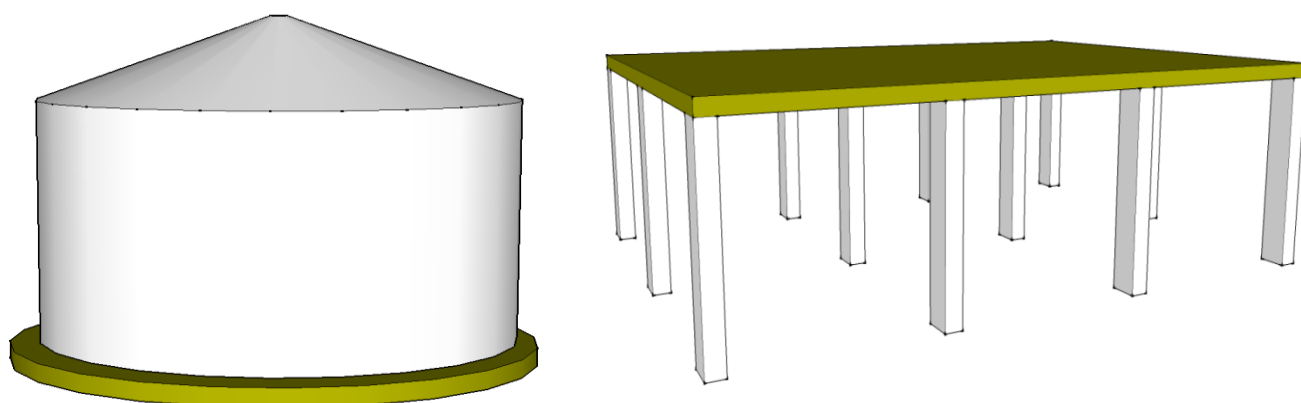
Ejemplos de construcciones que combinan distinto tipo de estructuras.
